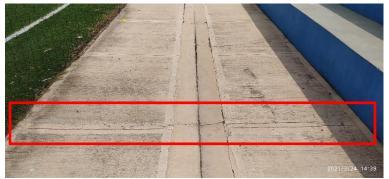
Fisuras en andén perimetral de la cancha – OCI 24-03-2021
